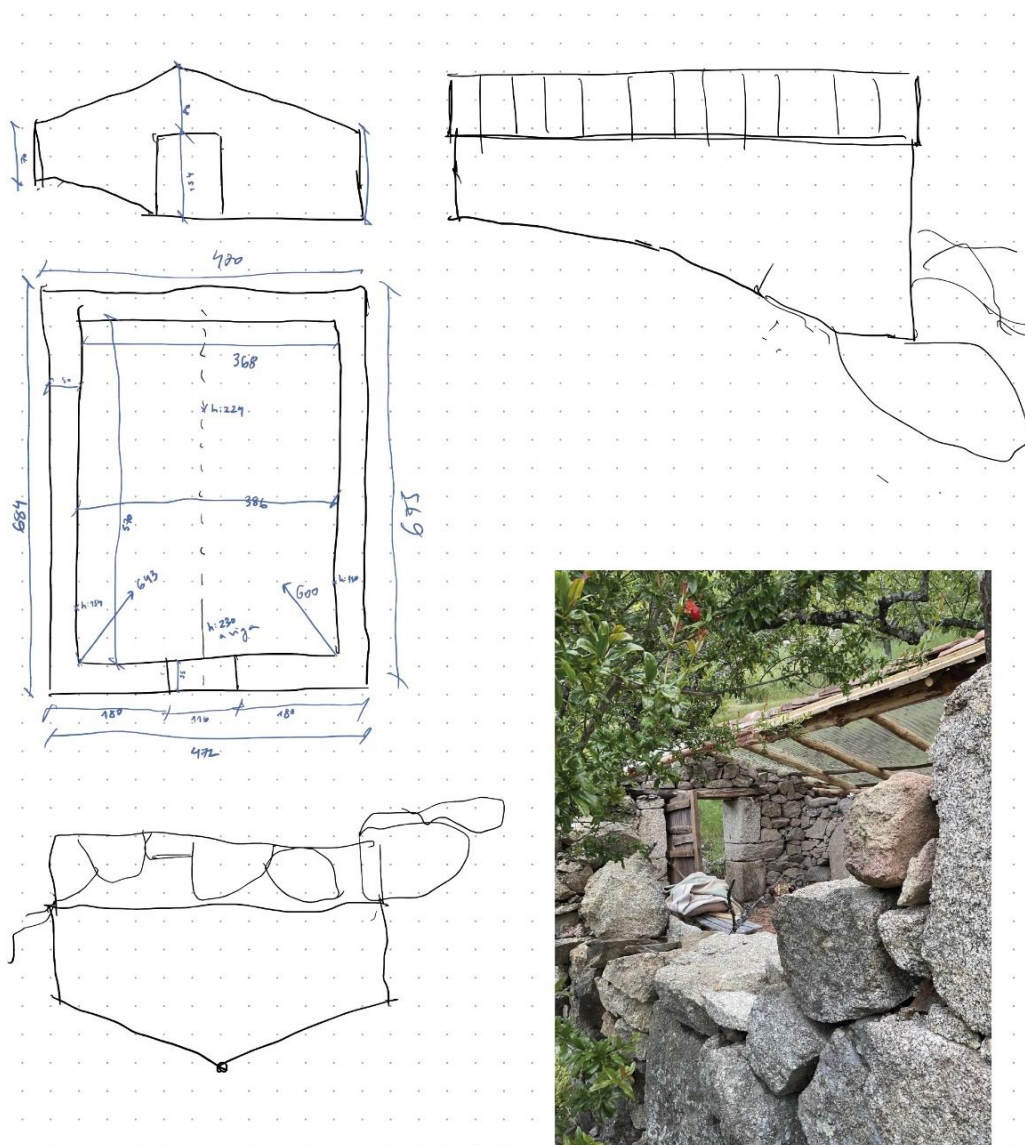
Apuntes para el Levantamiento. Construcción existente 2. Elaboración propia
